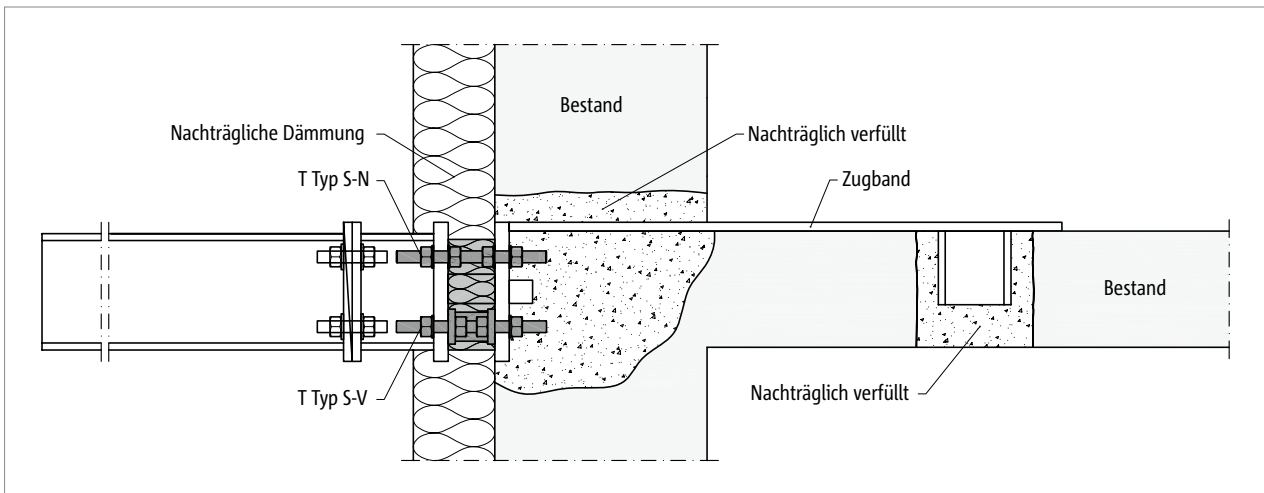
Schöck Isokorb® T Typ S-N und T Typ S-V: Nachträglicher Stahlbalkon mit Adapter, frei auskragend; mit Zugband angeschlossen an bestehende Stahlbetondecke
